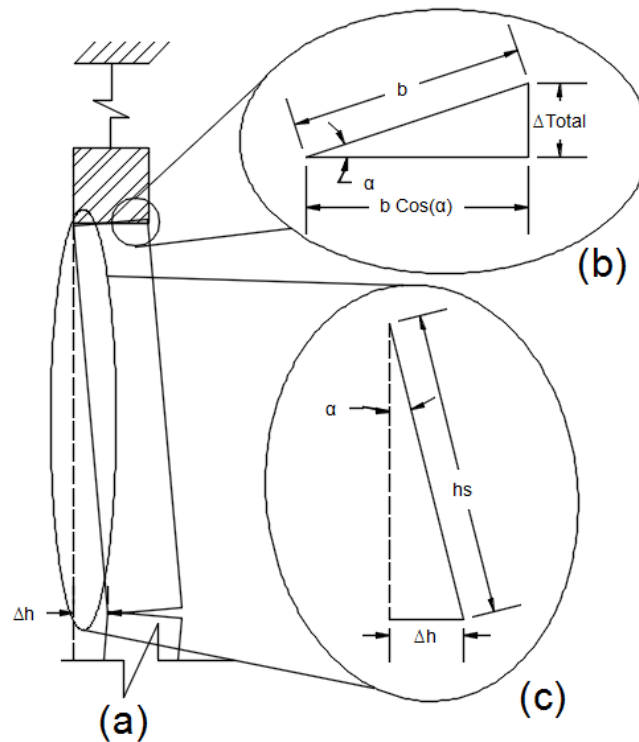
Detalle de la rotación que se observa en un muro sujeto a cargas fuera del plano
